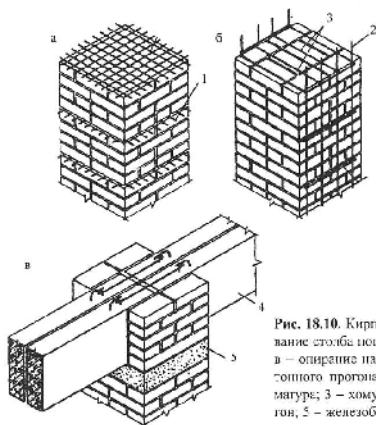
Кирпичные столбы: а, б — армирование столба поперечное (а) и продольное (б); в — опирание на кирпичный столб железобетонного прогона; 1 — сетка; 2 — продольная арматура; 3 — хомуты; 4 — железобетонный прогон; 5 — железобетонная опорная плита
